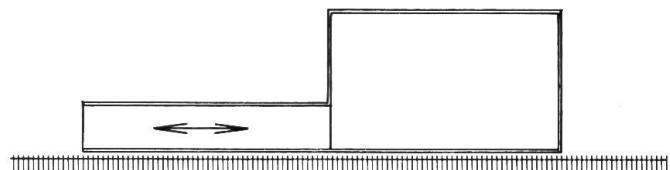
Quai de chargement surélevé en béton armé à une rampe avec locaux en dessous servant de garages ou d'entrepôts (projection horizontale).
